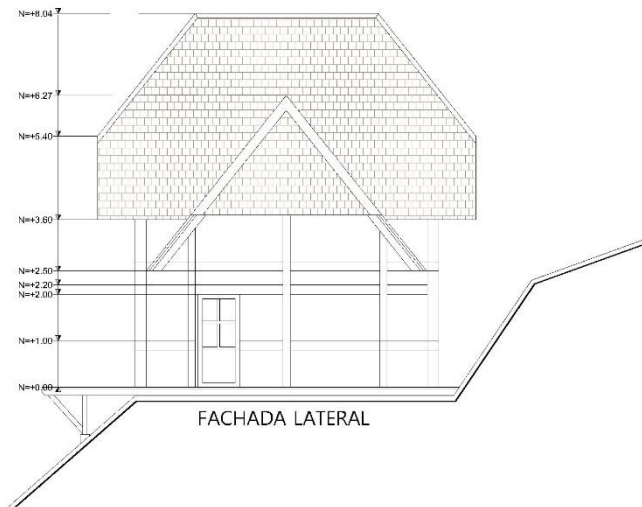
Plano arquitectónico cabaña y baterías sanitarias, fachada lateral
